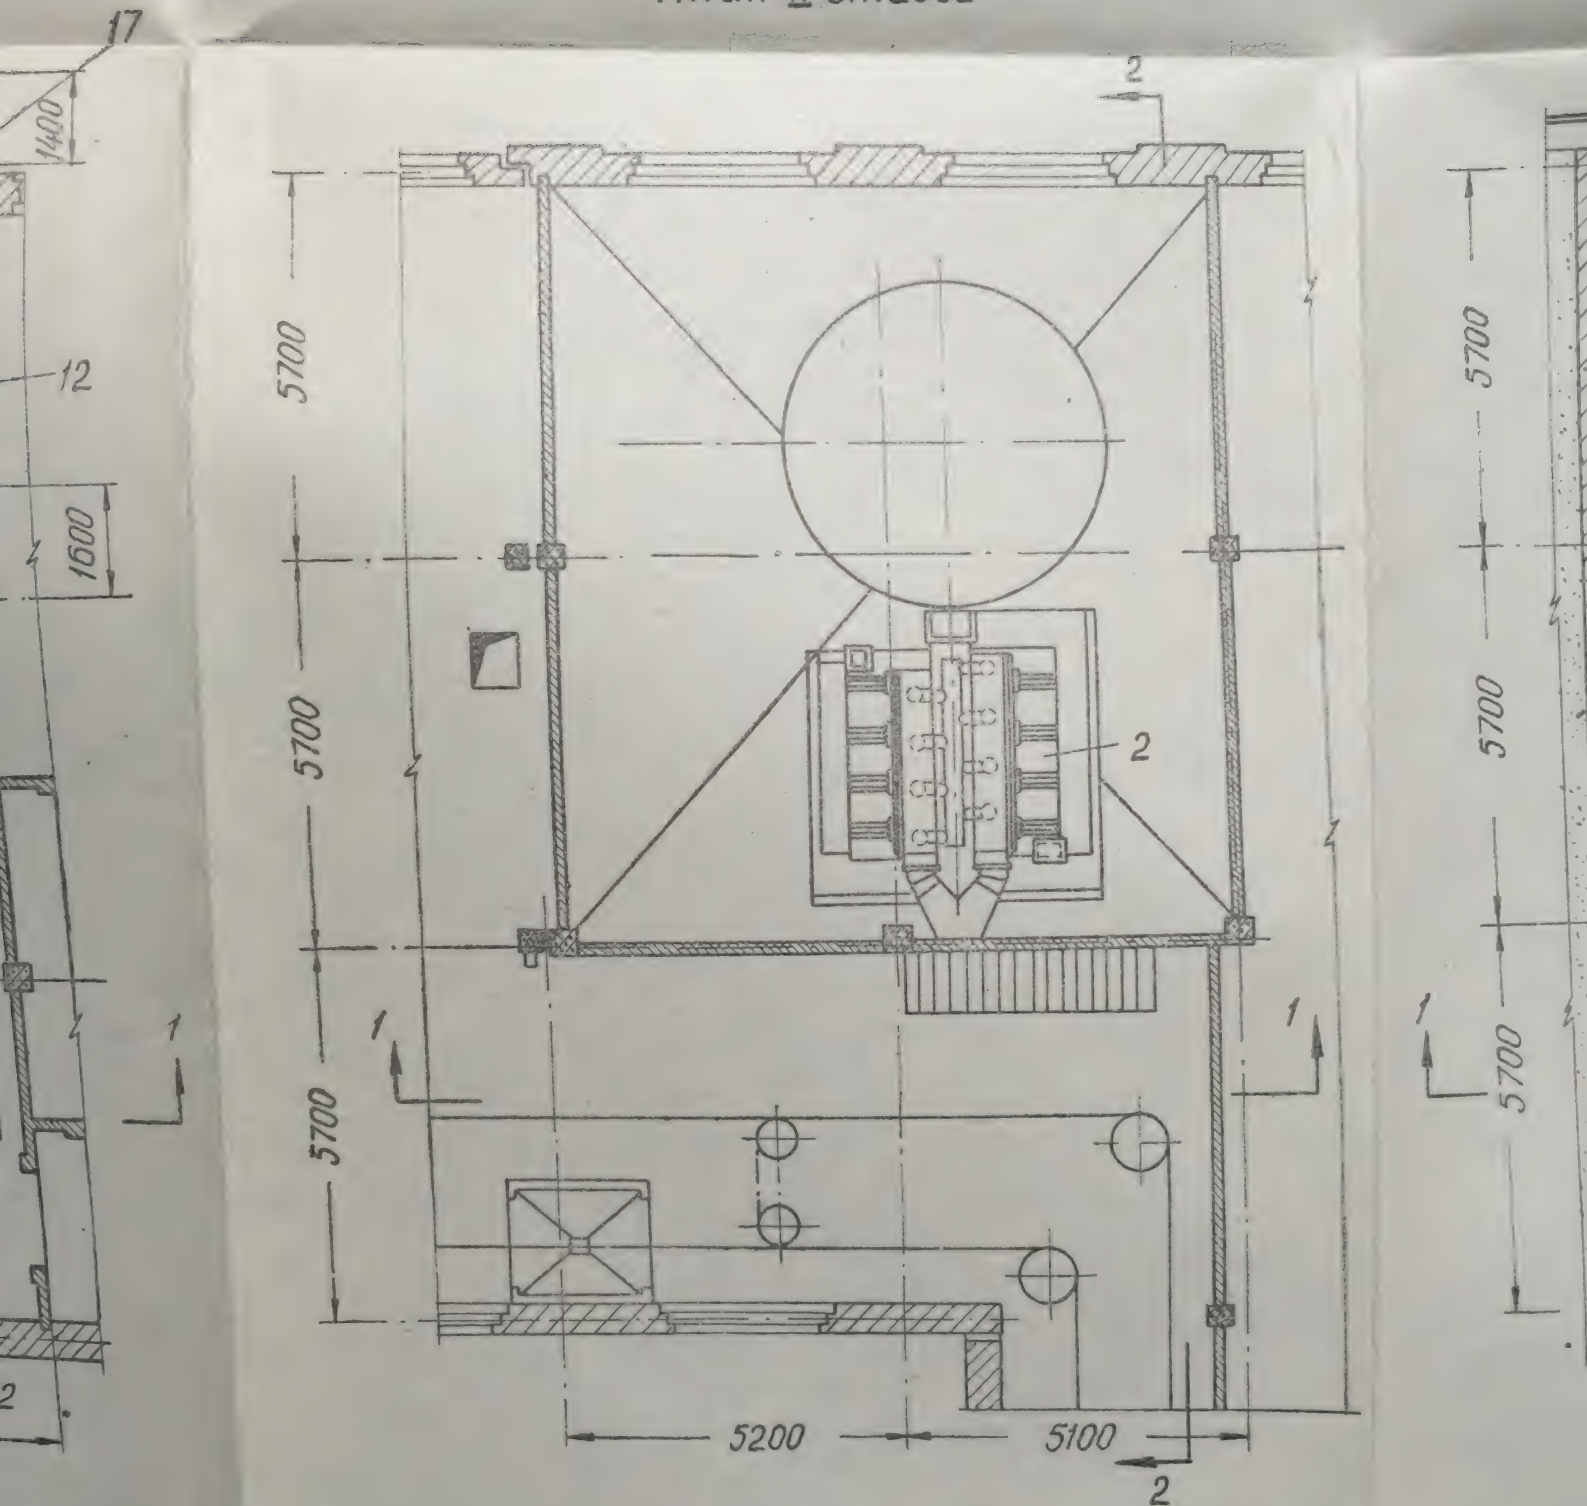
Установка распылительной сушилки для производства альбумина; 1—сушильная башня; 2—фильтровальная установка; 3—скребок; 4—транспортный шнек; 5—охладитель альбумина; 6—распылительная башня; 7—редуктор; 8—распылительный диск; 9—главный вентилятор; 10—вентилятор параллельного воздуха; 11—
